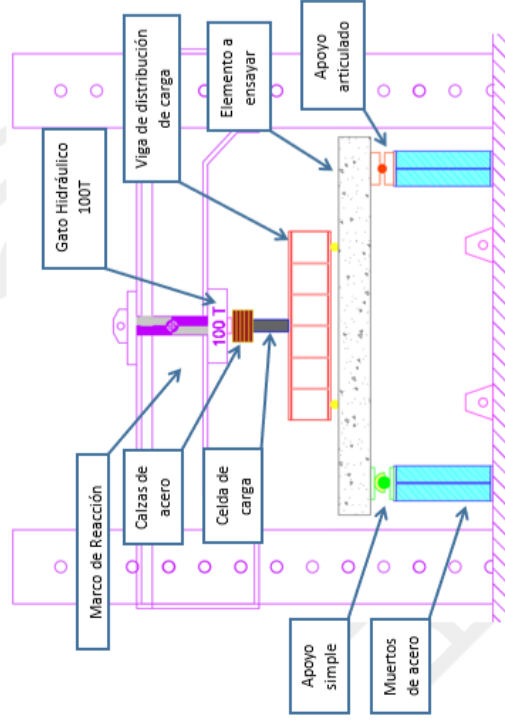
Montaje de la Viga de concreto reforzado en el marco de reacción.
